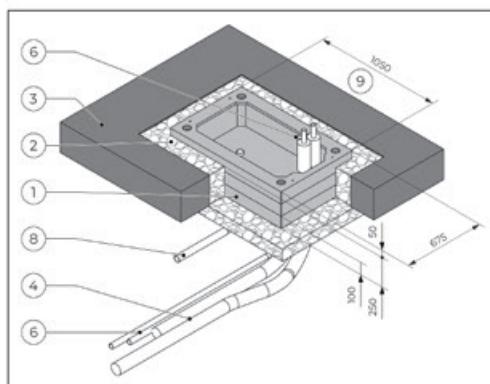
Betonsockel auf Unterlagsbeton [mm]
